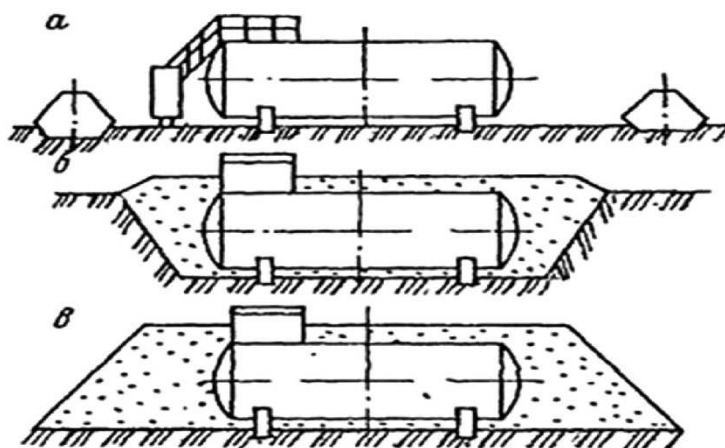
Схемы установки цилиндрических резервуаров:
